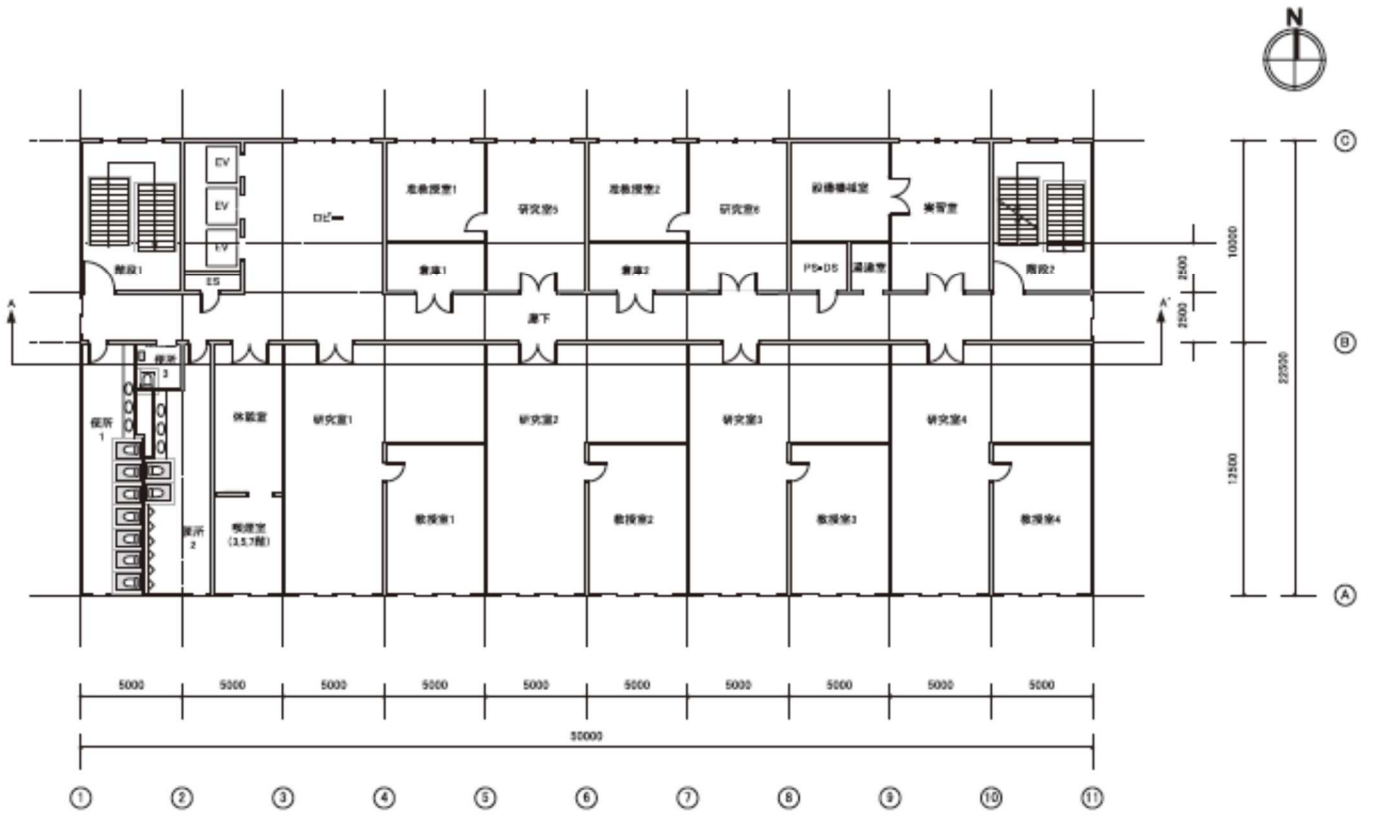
7 モデル建物（大学等、高層棟） 6～7階平面図
